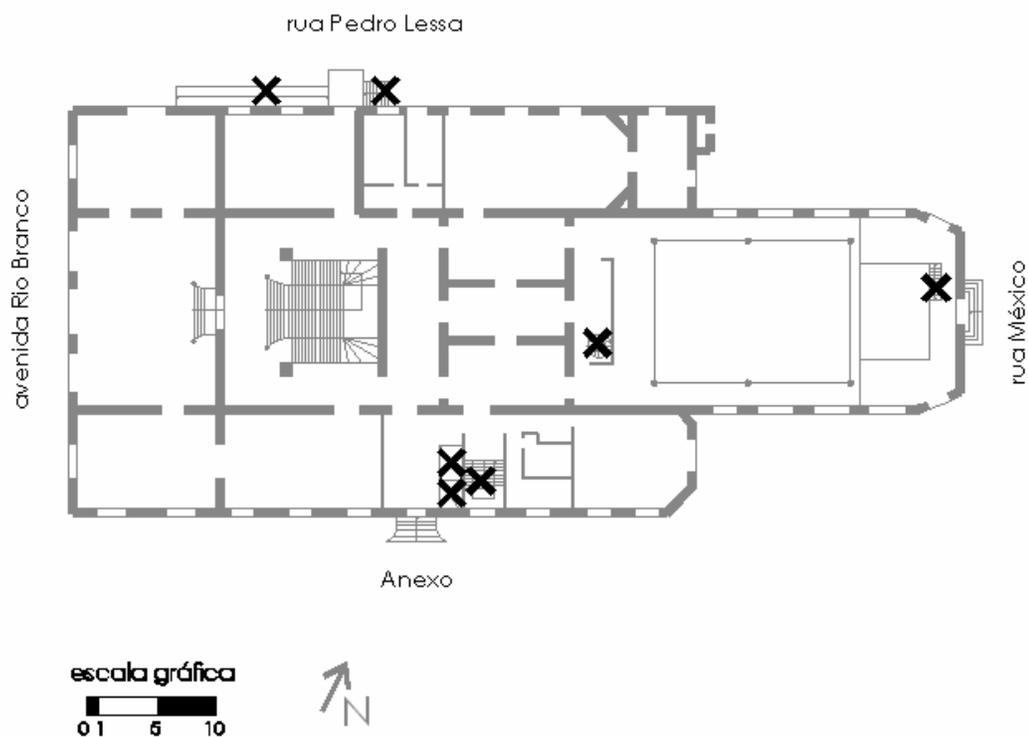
C.C.J.F. - Planta do pavimento térreo.
